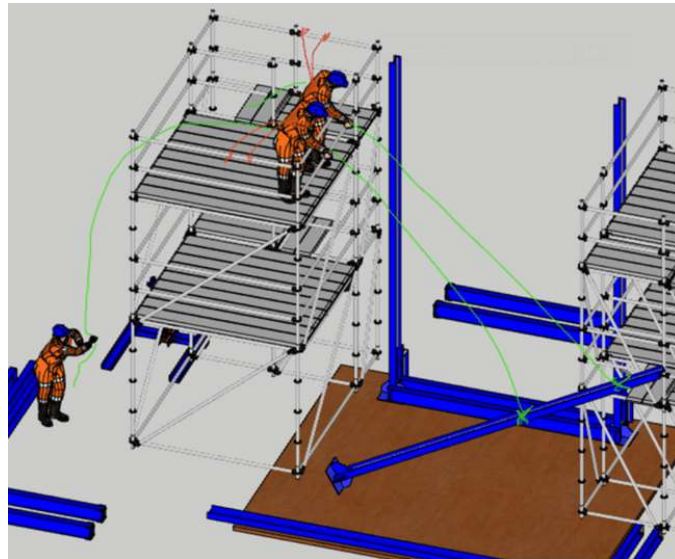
Pemasangan Balok *Hoist* (BH 1 dan BH2)
